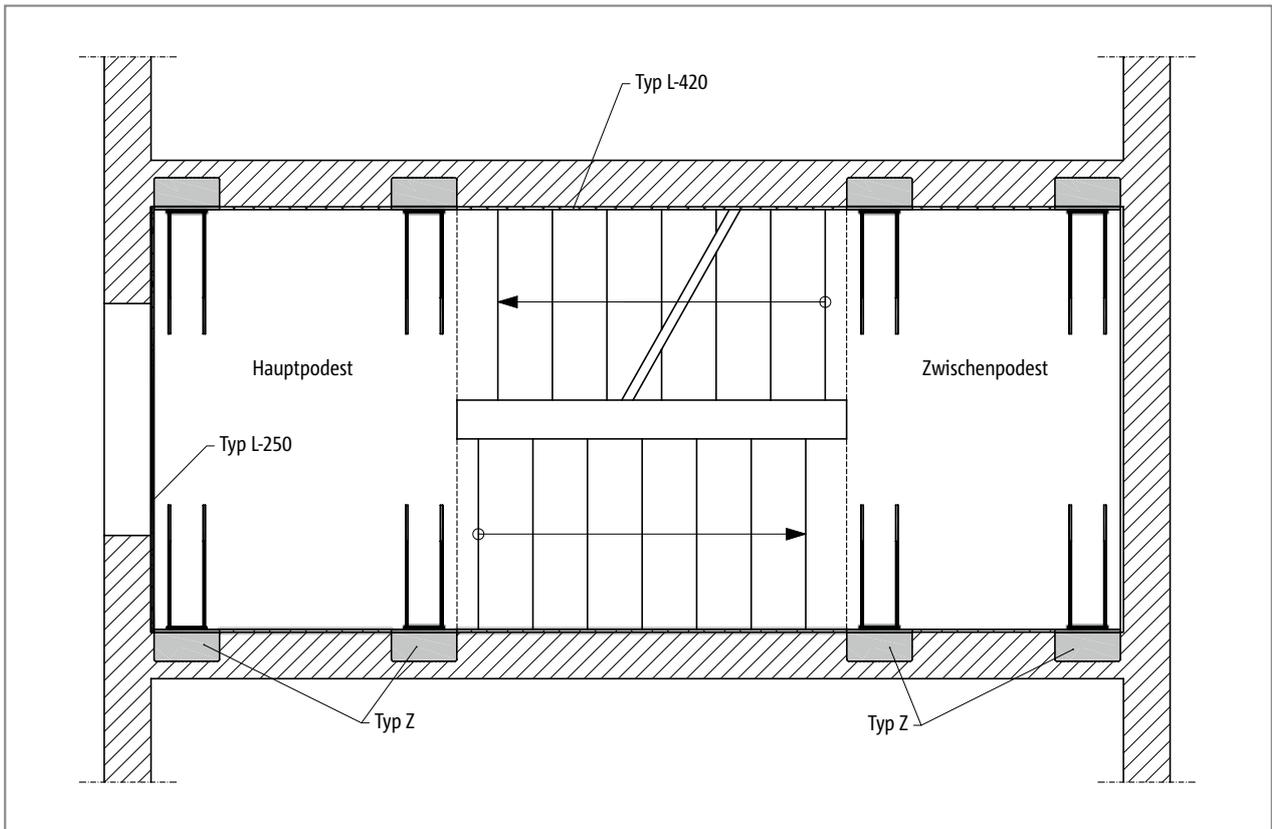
Schöck Tronsole® Typ Z: Elementanordnung im Grundriss
